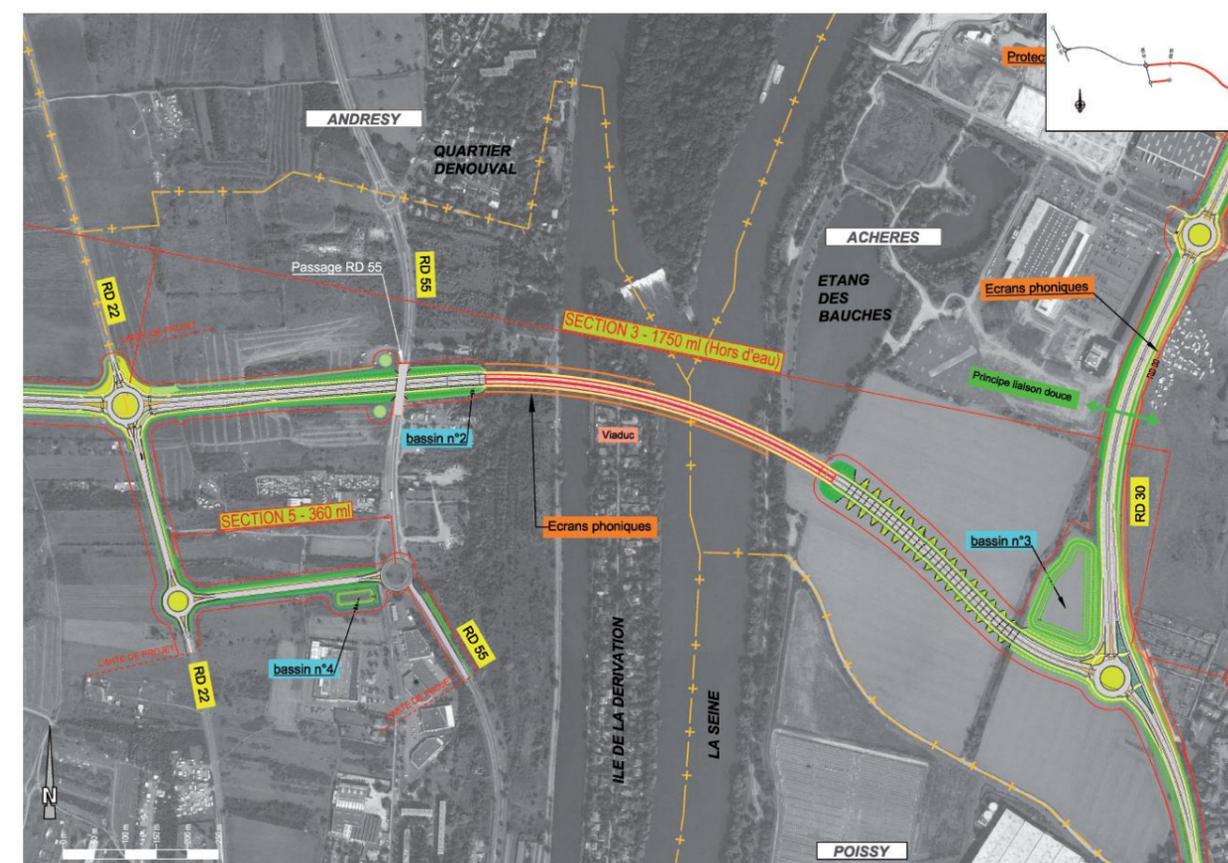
Plan Général des Travaux de la liaison RD30 – RD190
